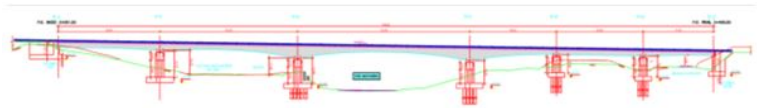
Viaducto de Porto. Alzado (tomado de planos del proyecto)
